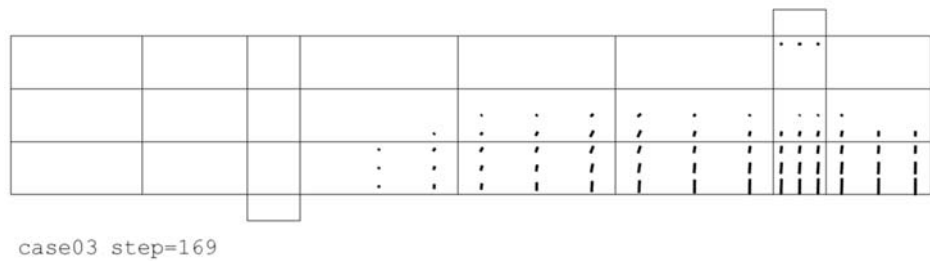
破壊時の変形及びひび割れ状態 (CaseNo. 3)
